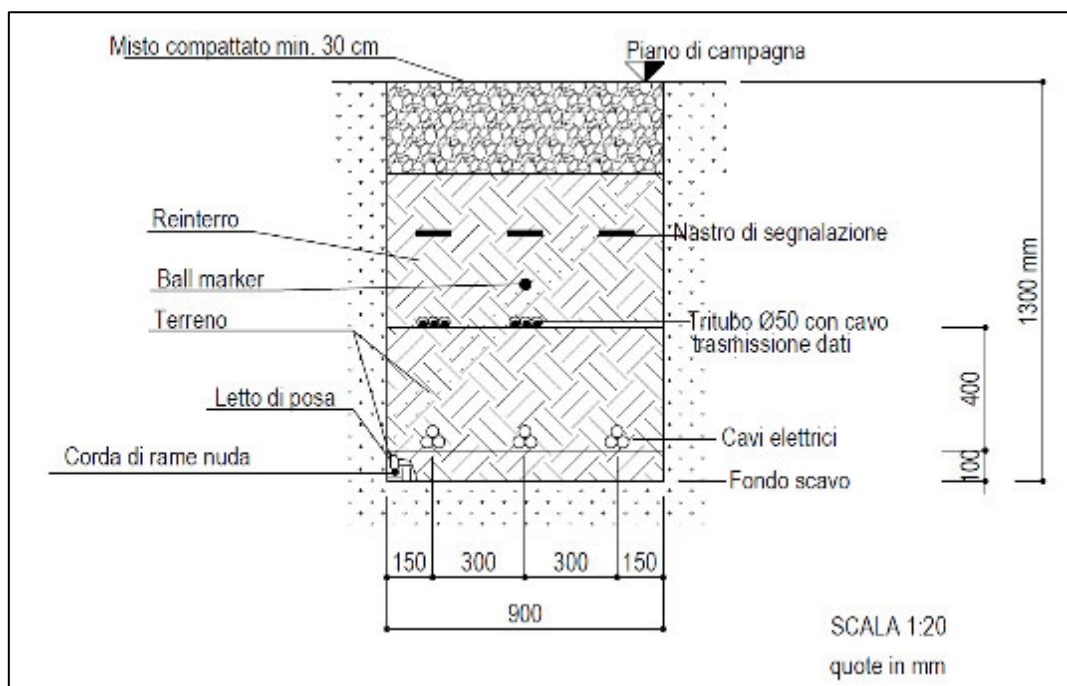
Tipico posa cavidotto su sterrato con 3 terne
